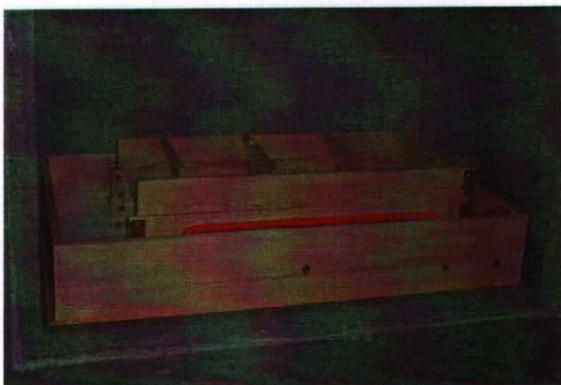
Einbau der Dachbodentreppe in der Prüfkammer
